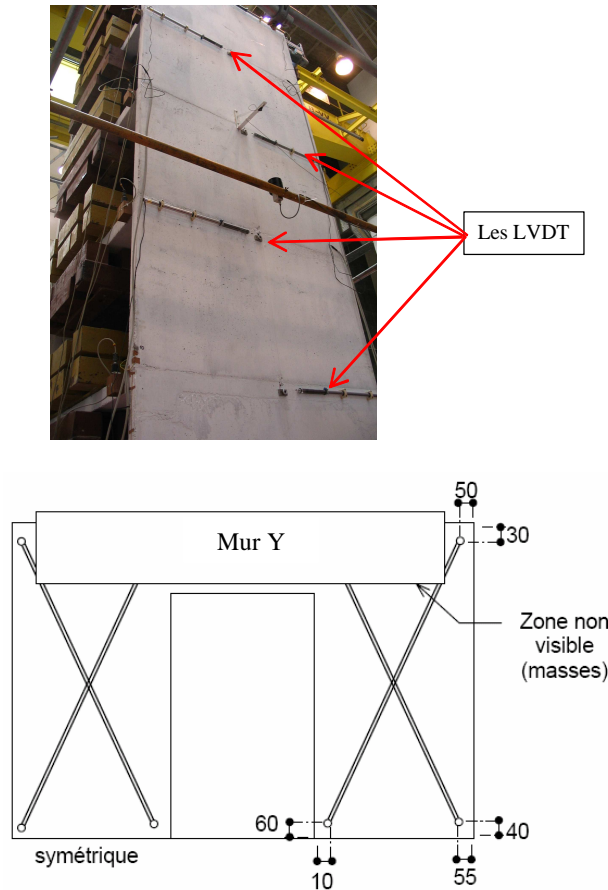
Maquette ECOLEADER : Disposition des LVDT (unités en mm)
